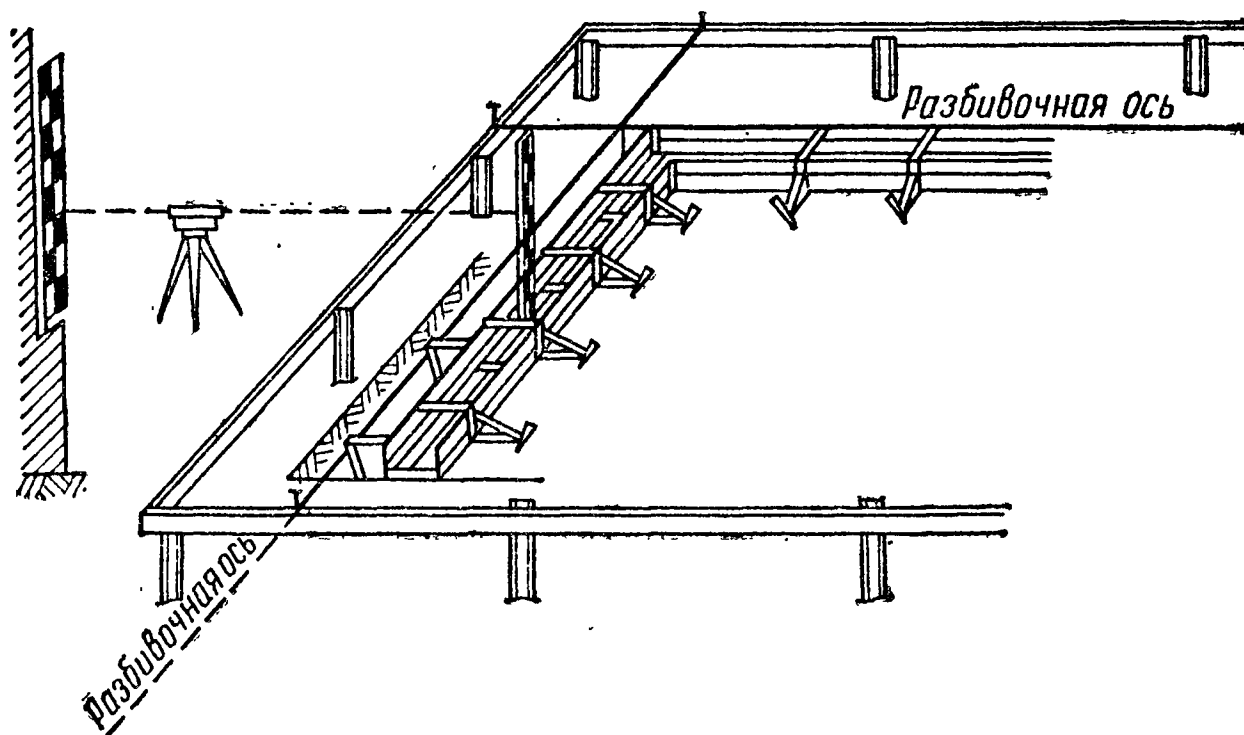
Разбивка опалубки монолитного ленточного фундамента
